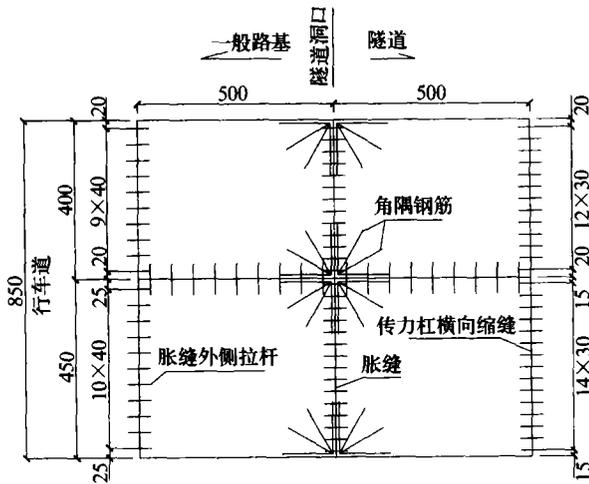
水泥混凝土路面传力杆及角隅钢筋布置示意图
